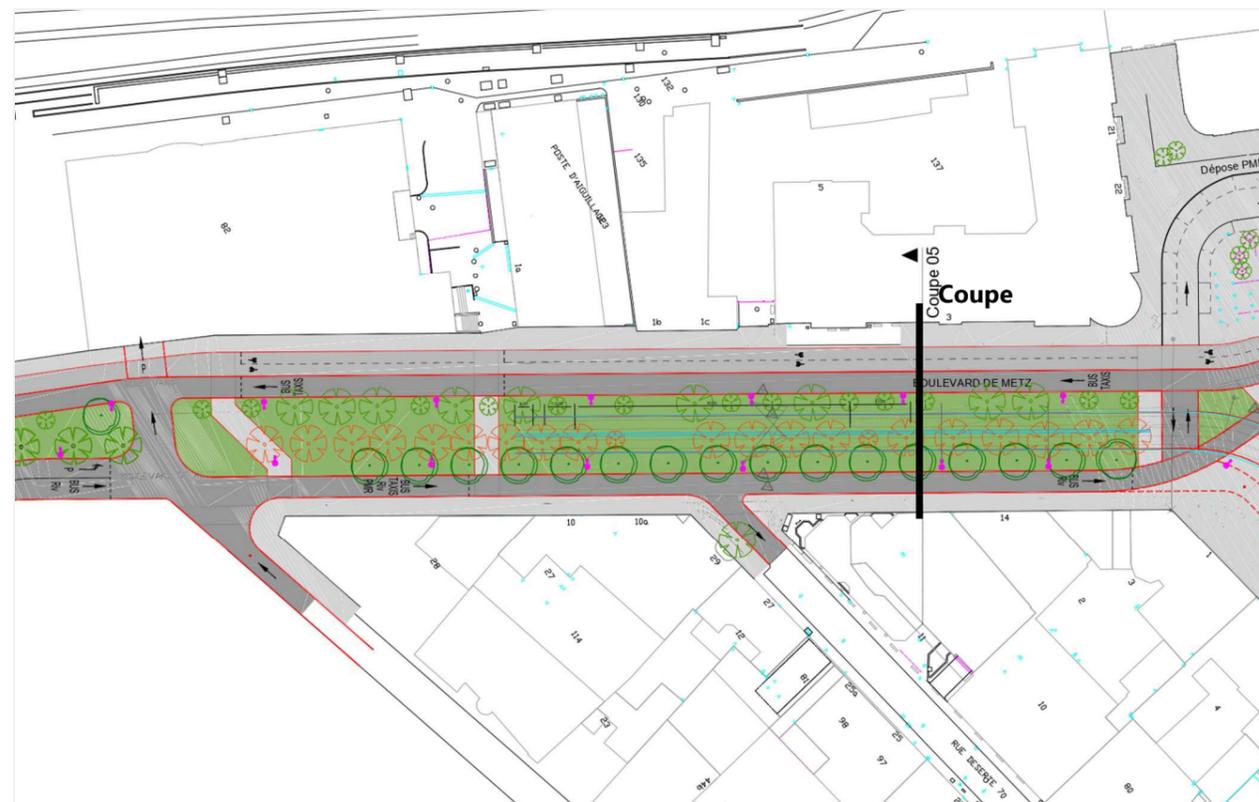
Plan de l'aménagement sur le boulevard de Metz (source : AVP GETAS 2023)
